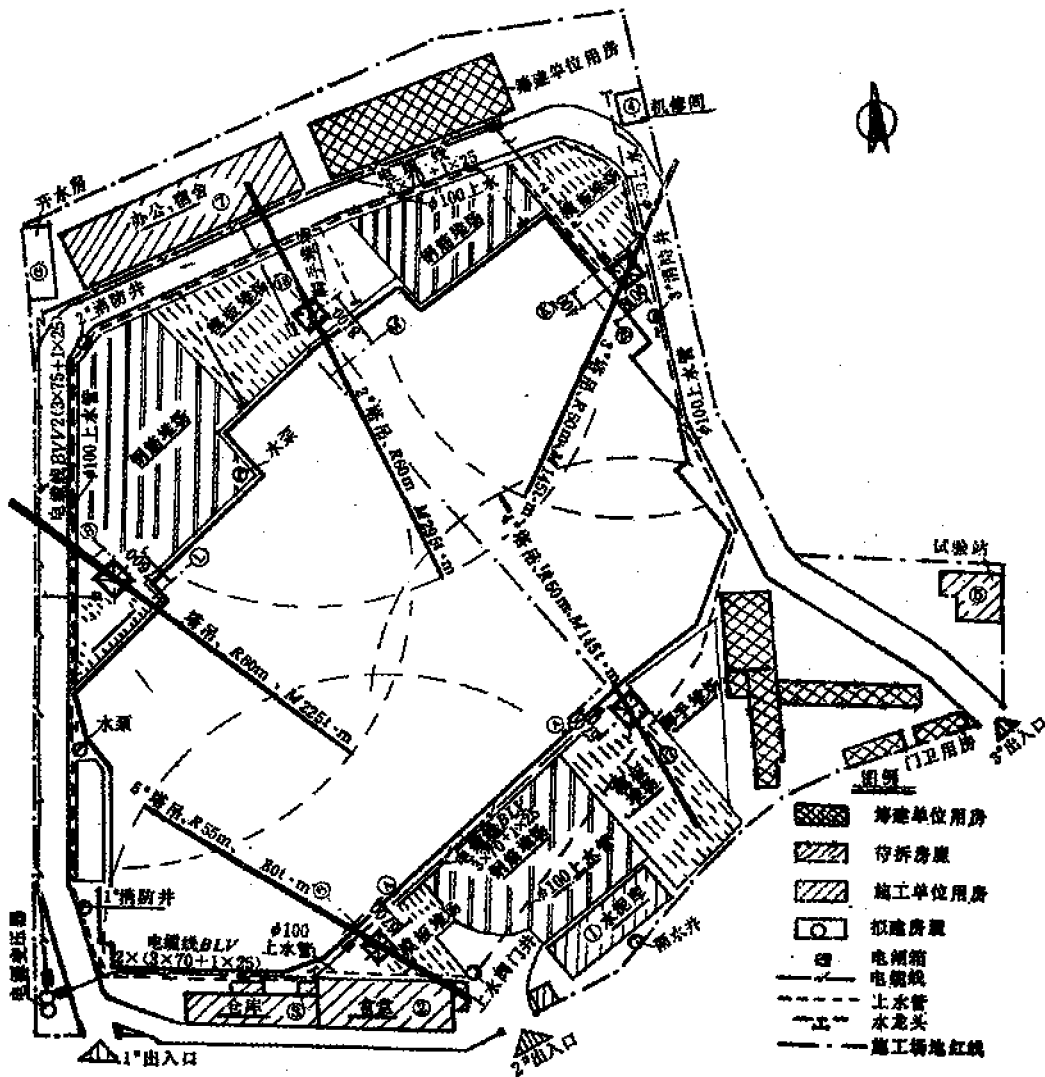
(6) 北京城乡贸易中心工程地下室施工平面图
